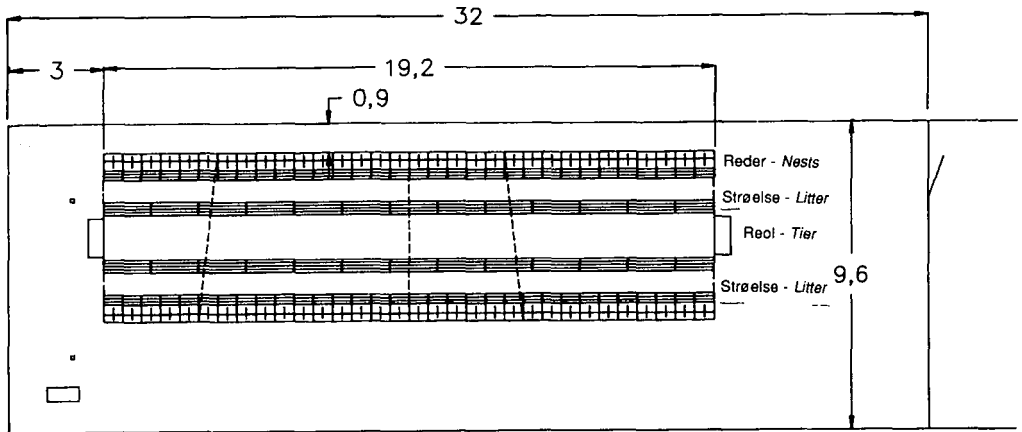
Grundplan af BOLEG systemet med placering i forsøgsstalden, mål i m
